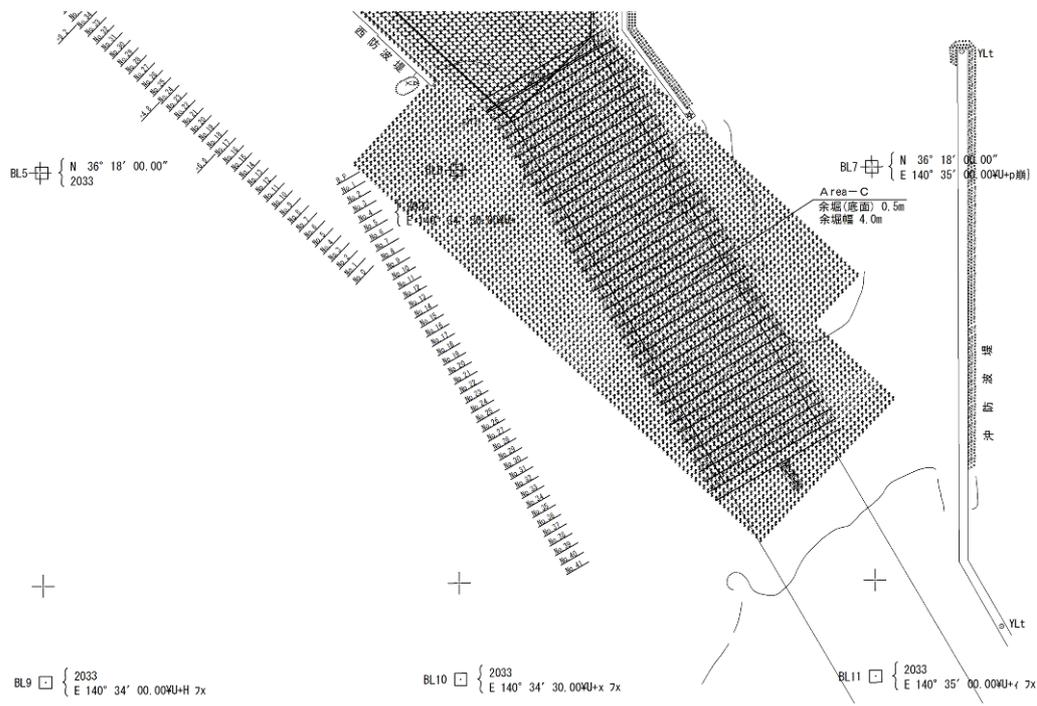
301 No.1 大洗港区_中央地区航路 (-8m) の平面図 (被災前)
